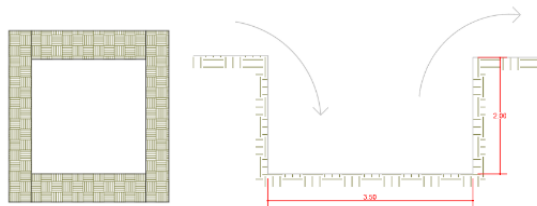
Vista en planta y detalle del obstáculo de terraplén y fosa caída.
